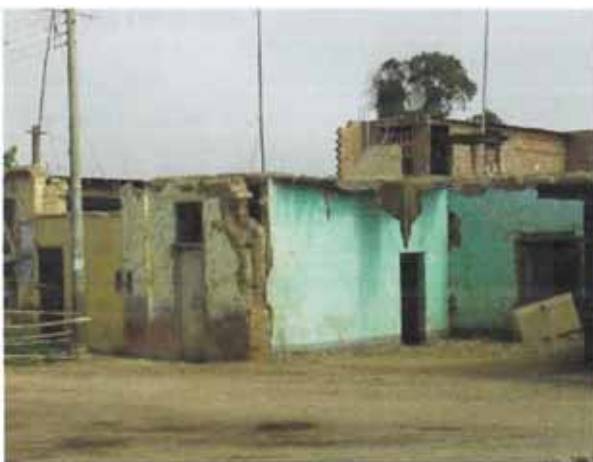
VIVIENDA EN MAL ESTADO.
